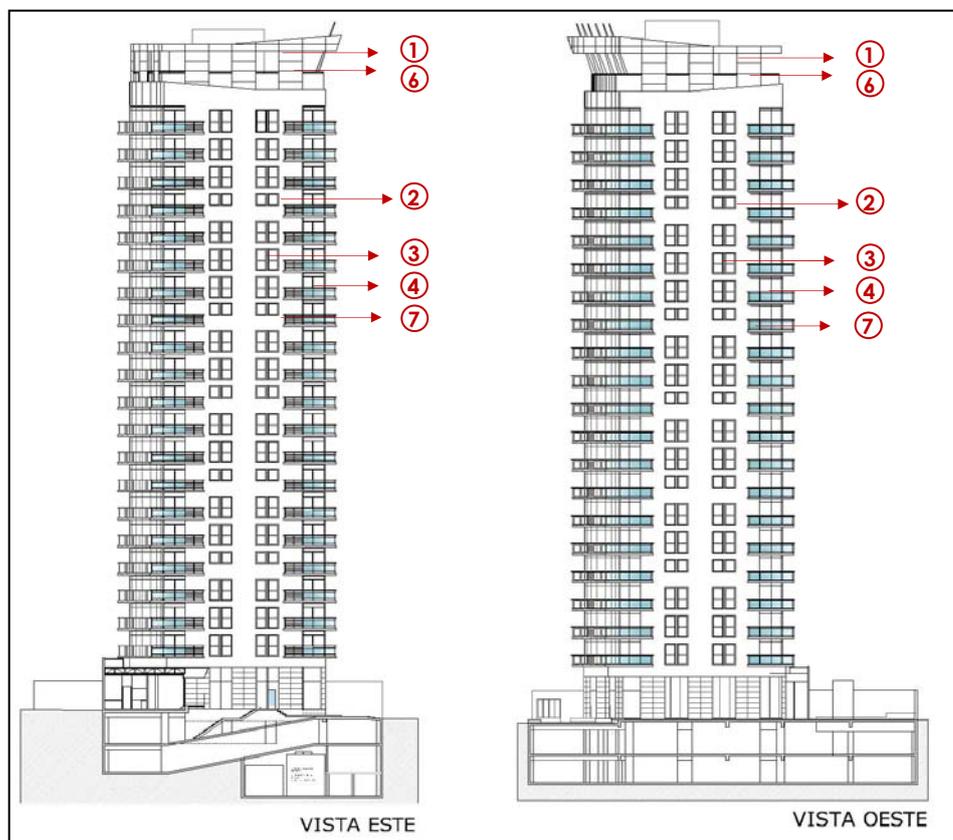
Fachadas Este y Oeste del edificio Da Vinci
